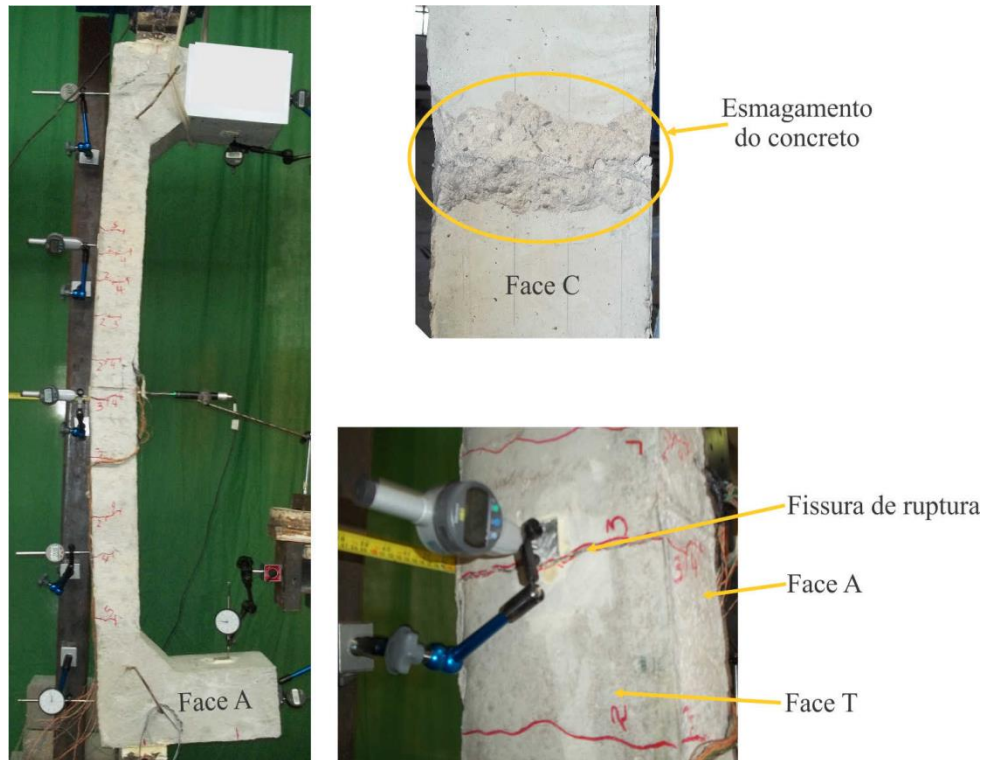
13 - Região de ruptura do pilar original (P_0)
